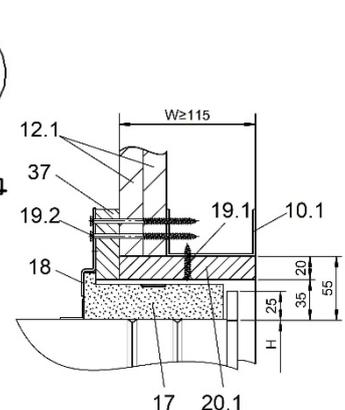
Trockeneinbau mit Einbaurahmen ER-P1 in Schachtwand
